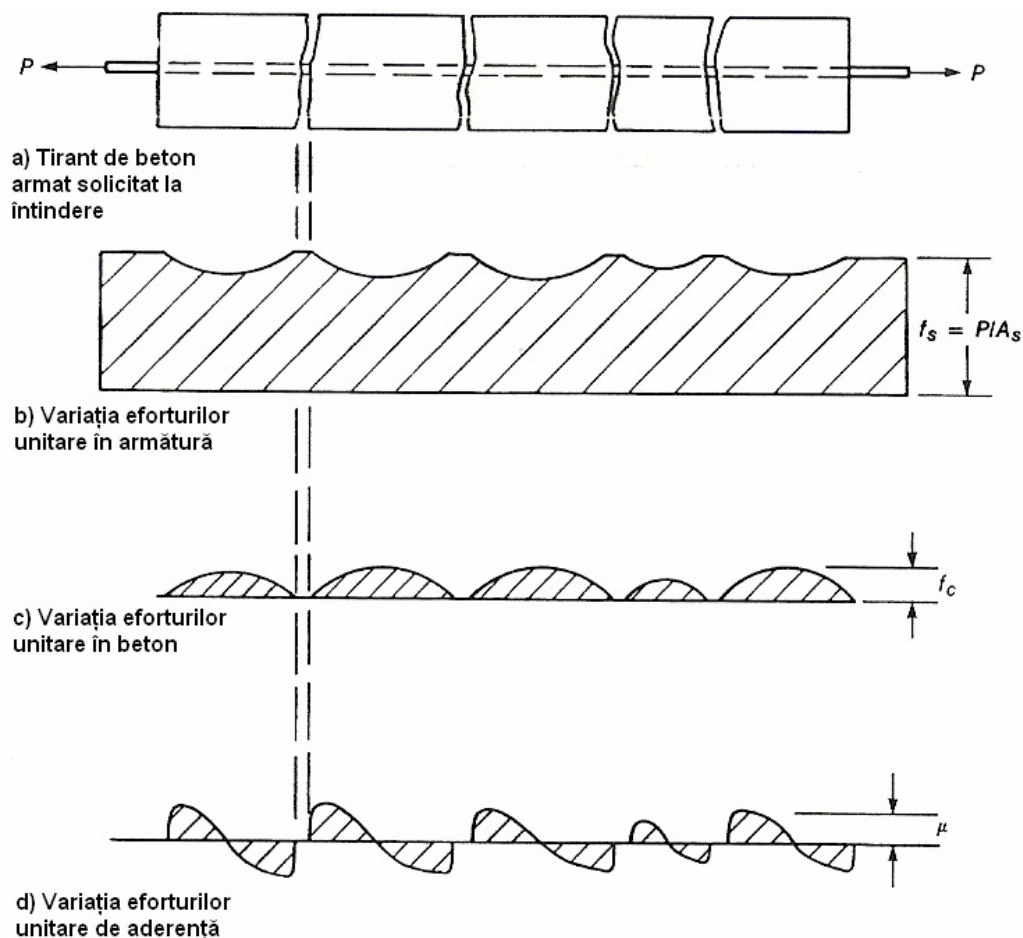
Eforturi unitare în beton, în armătură și eforturi unitare de aderență într-un tirant de beton armat
